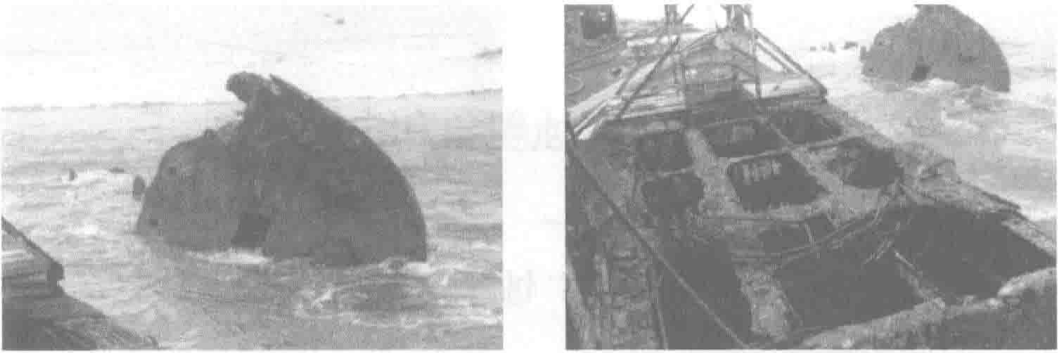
第二次世界大战后放置在硫磺岛的钢筋混凝土船混凝土和钢筋的腐蚀
